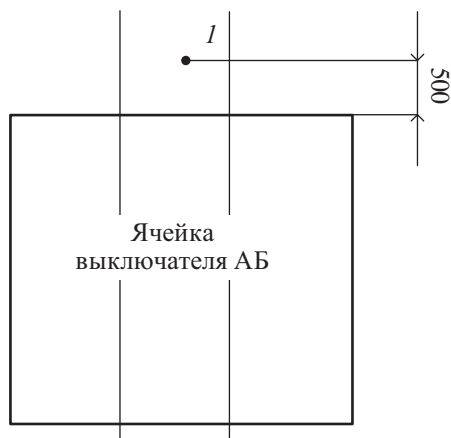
Эскиз ячейки выключателя АБ фидера № 11 (вид сверху)
